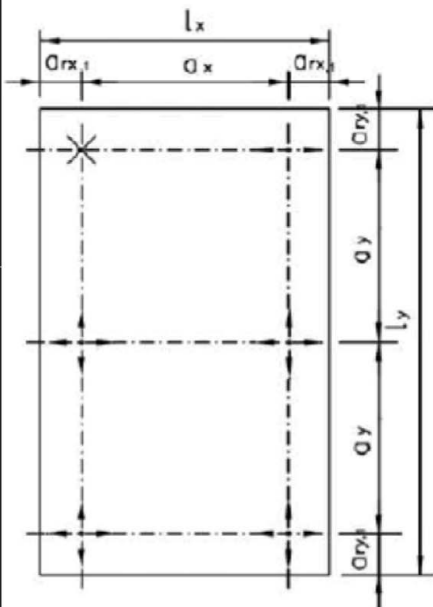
Fassadeplatte mit 6 Agraffen – Lagerungsart 2
